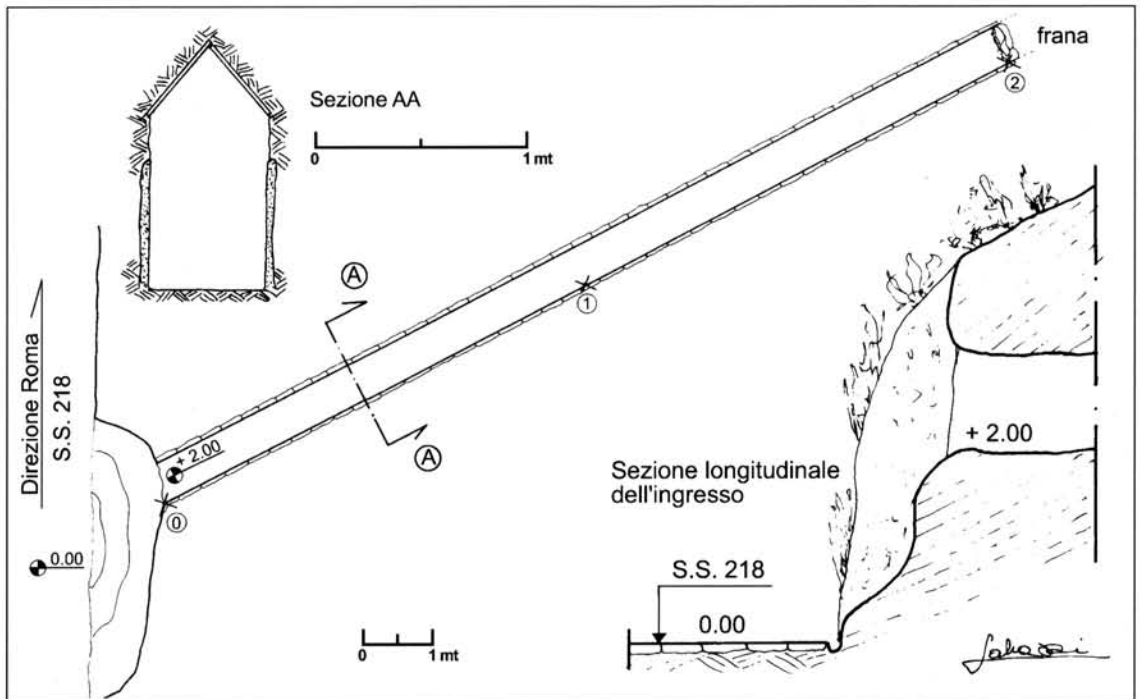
Pianta e sezioni della CA122 (grafica C. Germani, A. De Paolis)
